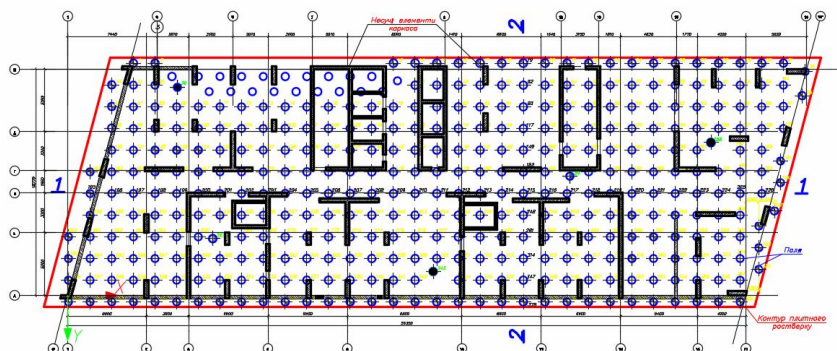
План взаємного розташування паль, плитного ростверку та несучих елементів каркаса будівлі на рівні верху плитного ростверку
